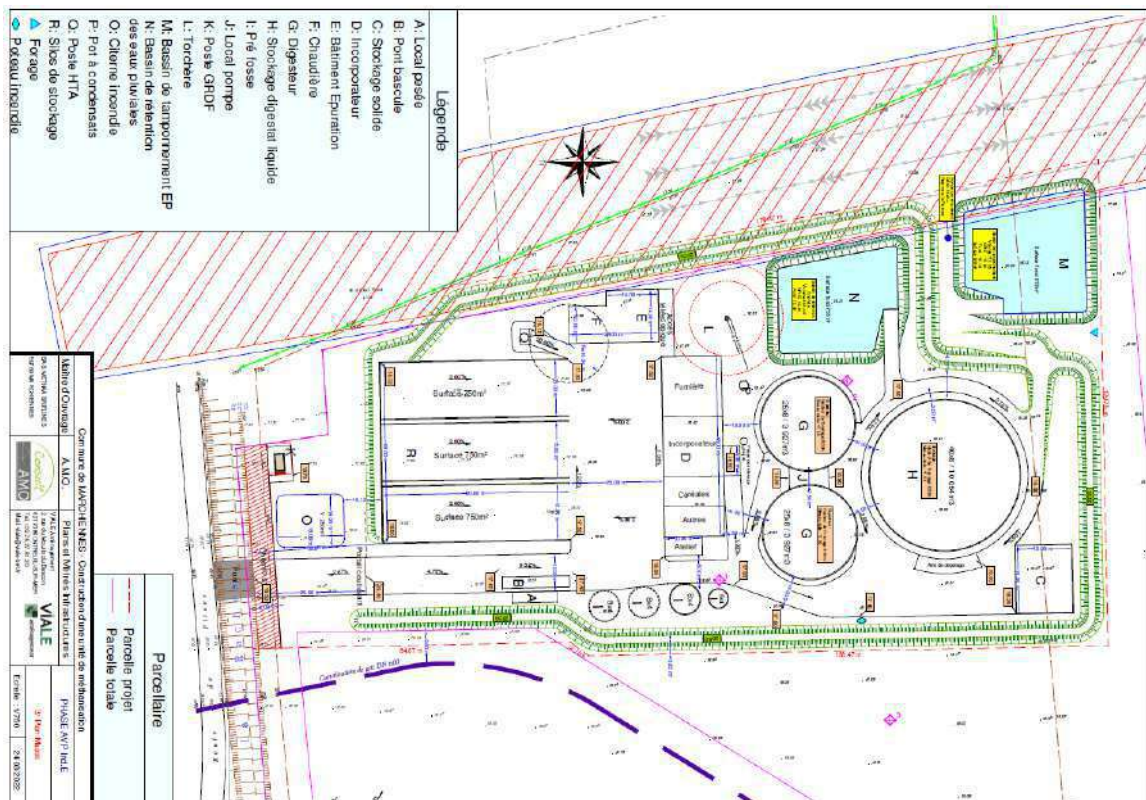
Plan de masse projet (indice E) du 24/03/2022
